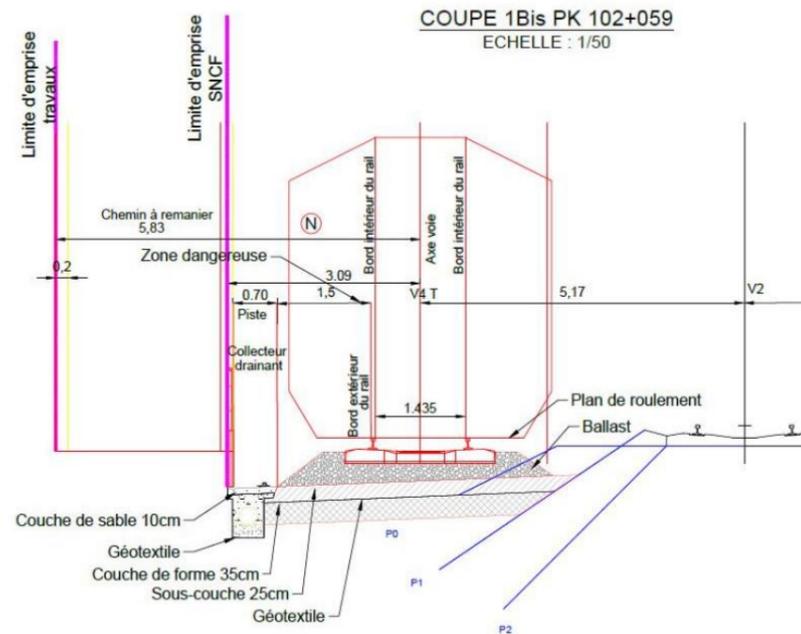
Coupe voie 4 tiroir Carnoules avec collecteur drainant (Systra, 2021)
